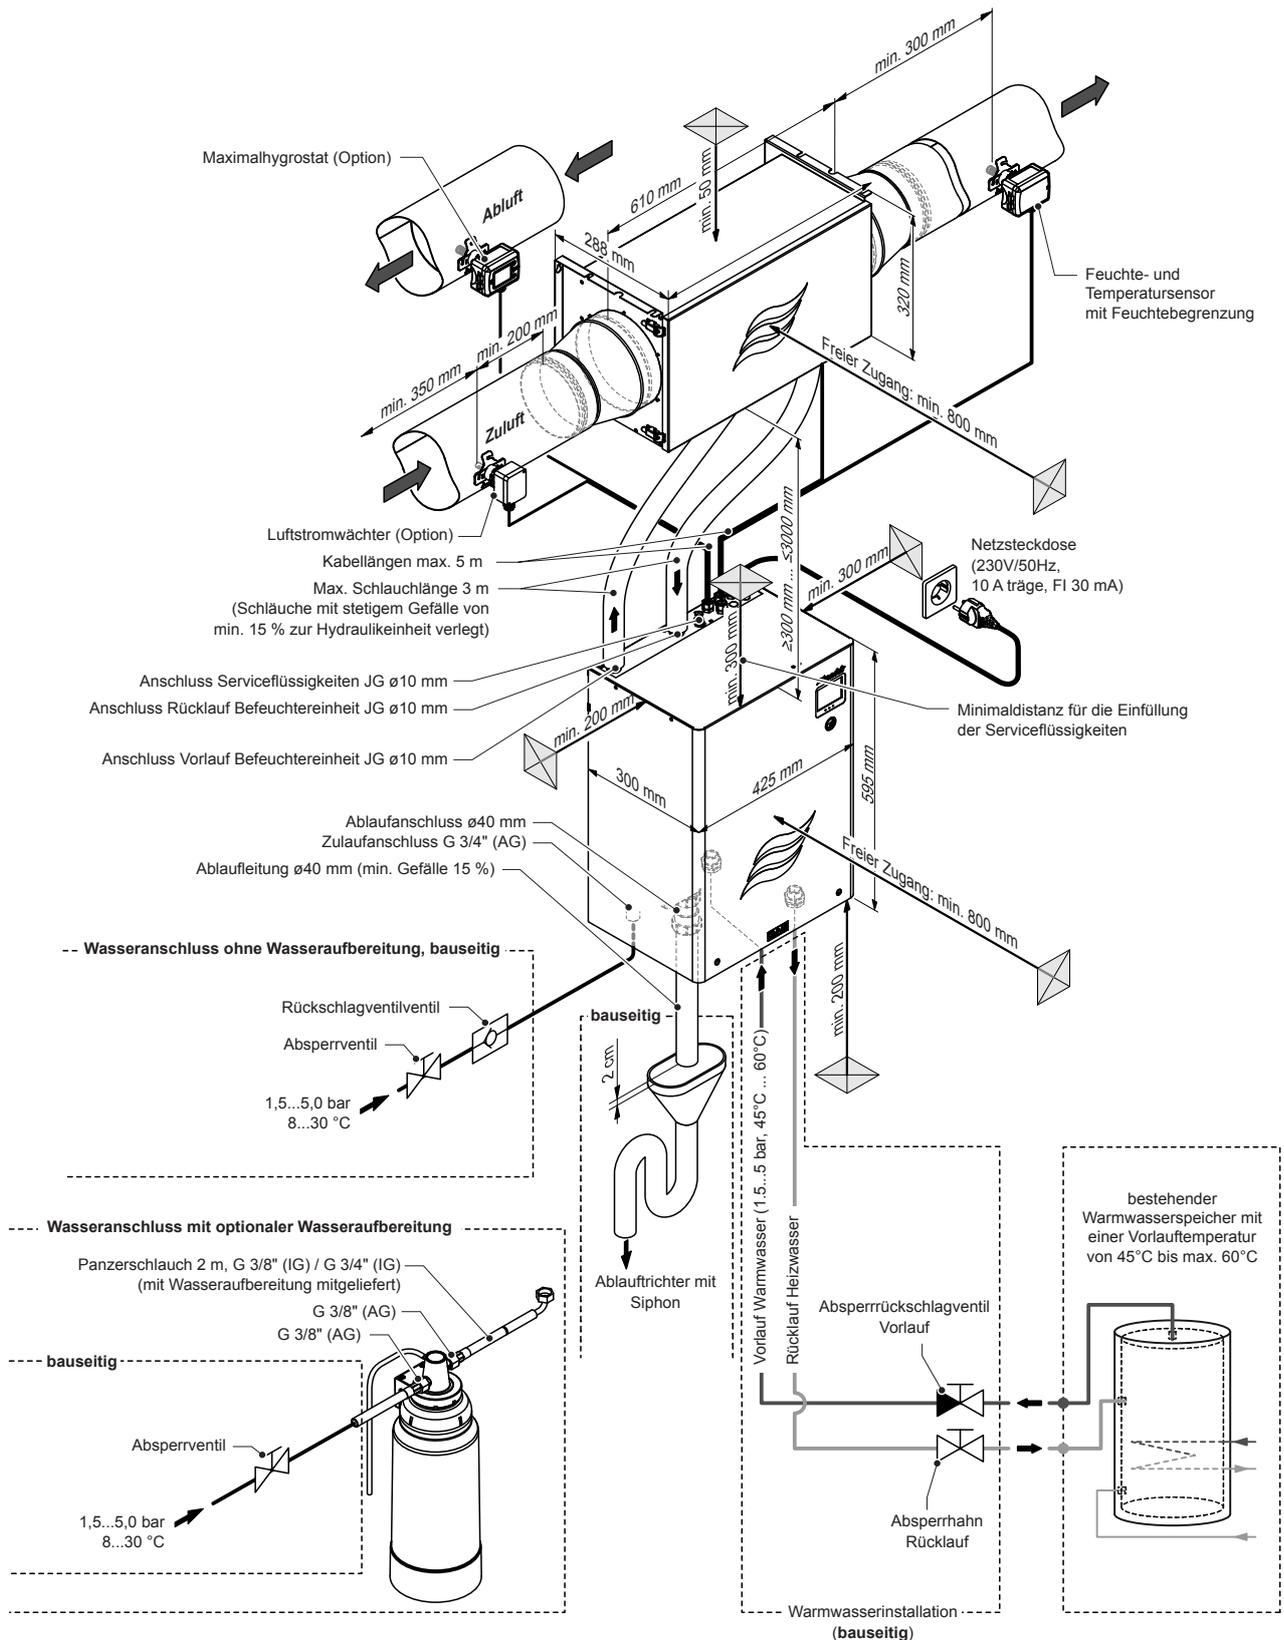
Installationsübersicht Condair MD Variante MD-WW-H
